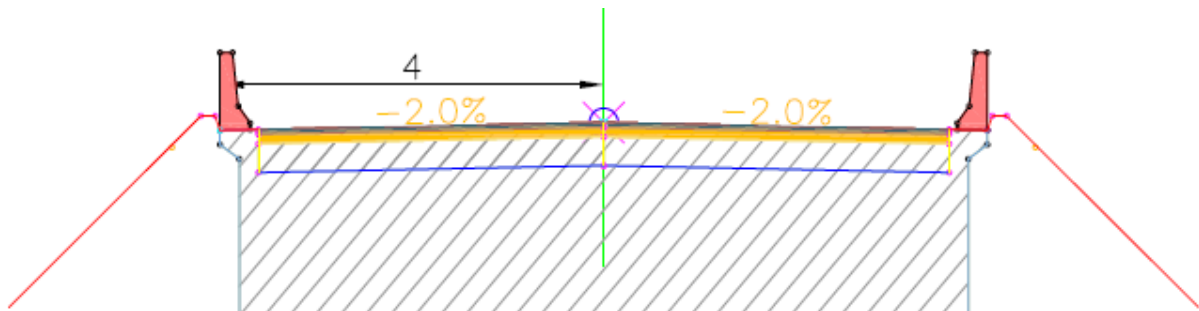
Profil en travers type de la route avec l'ouvrage.
